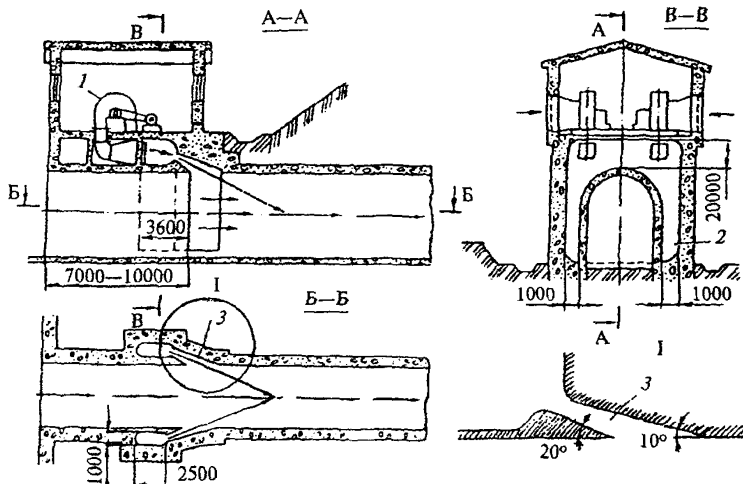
Конструктивная схема портальной вентиляции с открытыми входами
